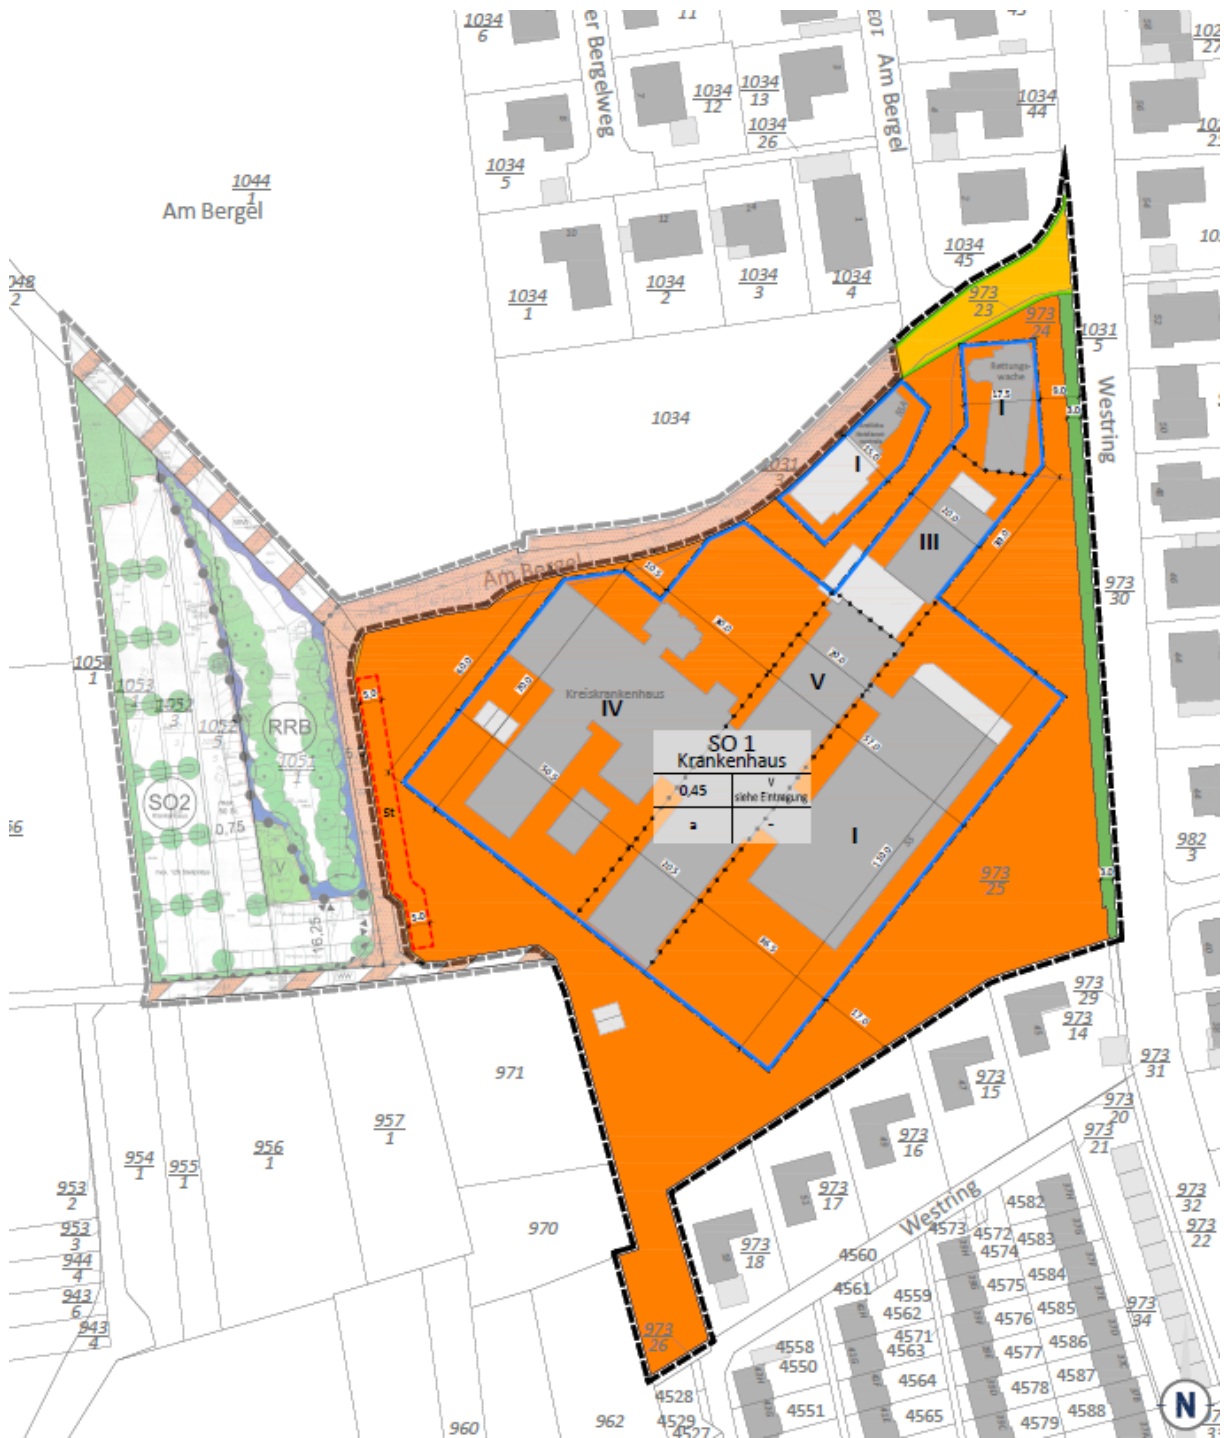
Bebauungsplan „West II, Teilbereich Kreiskrankenhaus mit Parkplatzerweiterung, 5. Änderung“ (Stand: August 2025)
